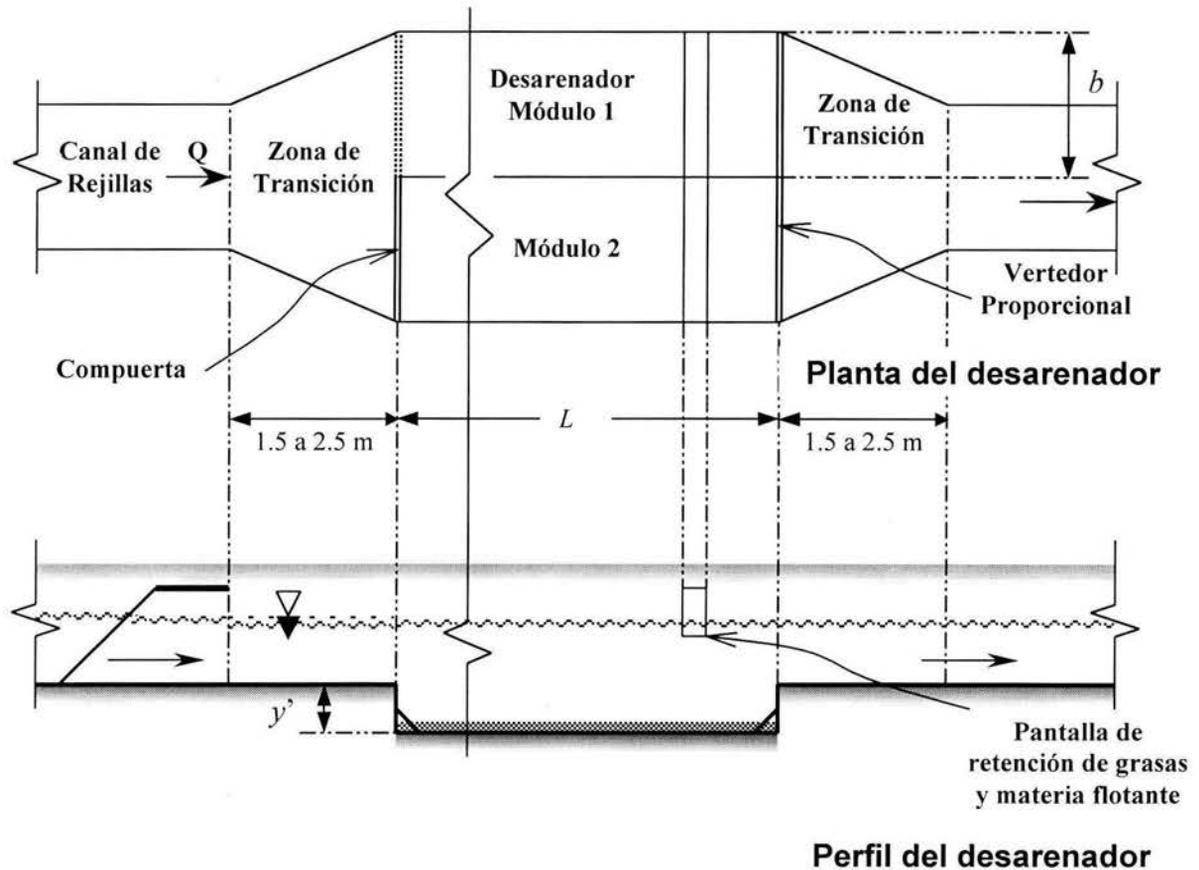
Perfil y planta de un tanque desarenador
